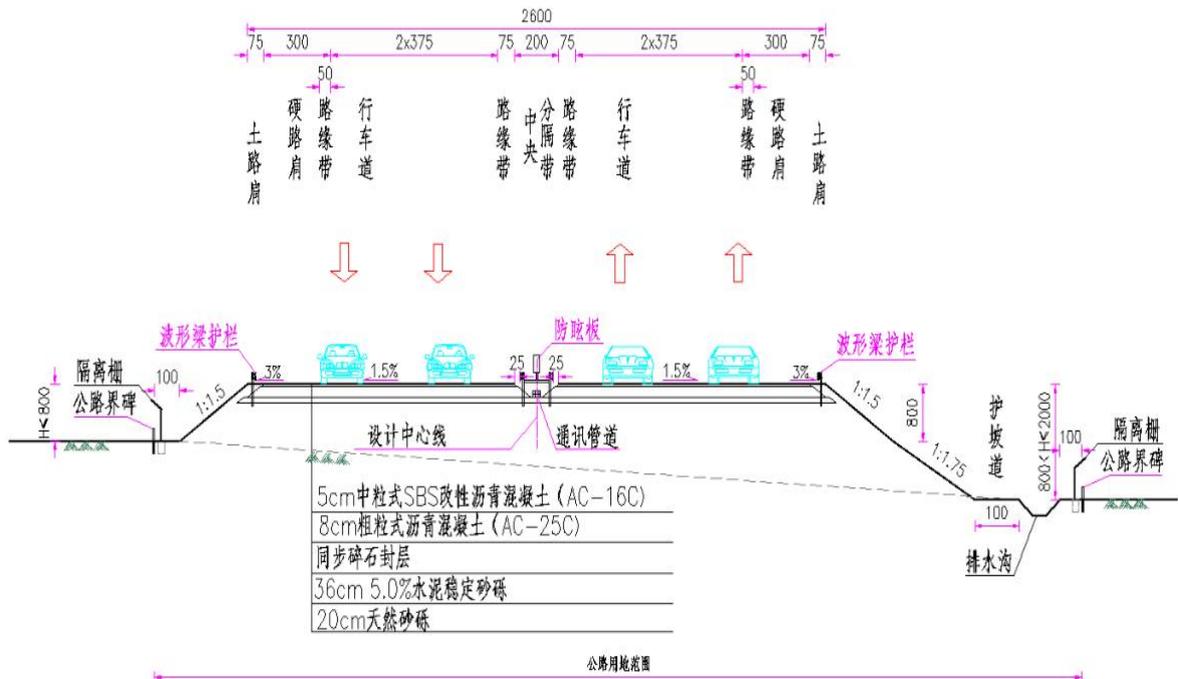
双向四车道 26m 宽一般路基标准横断面图
